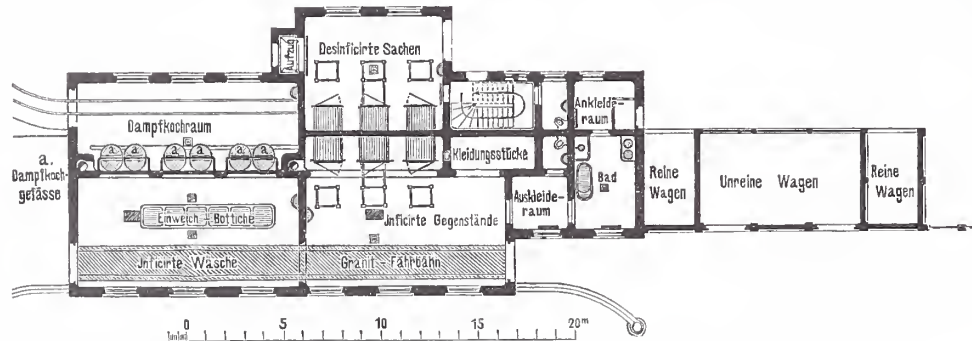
Grundriss der Desinfektionsanstalt in Eppendorf.
